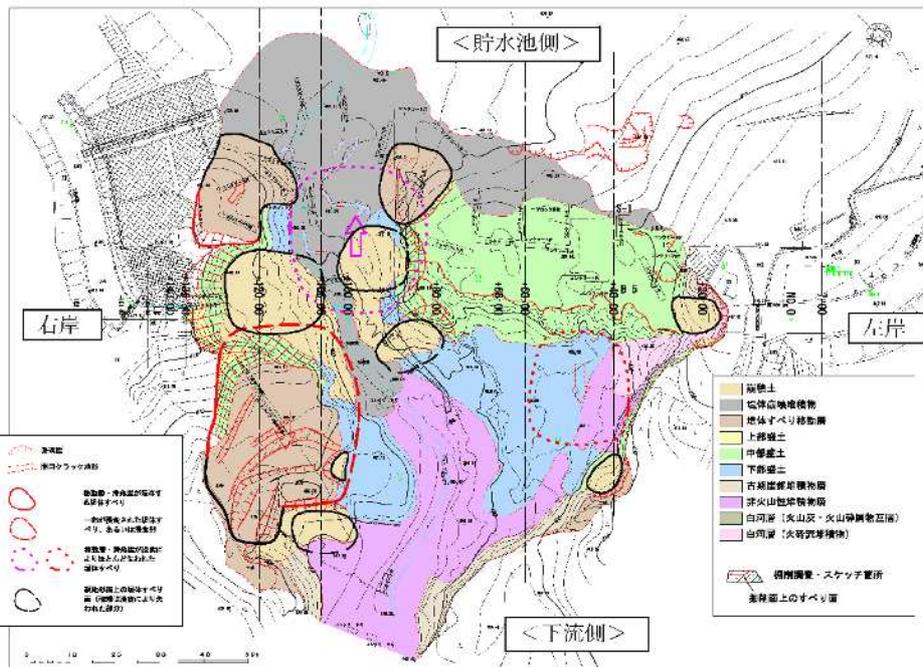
被災後の藤沼ダム（本堤）地質平面図と地形・地質から想定される堤体すべり
